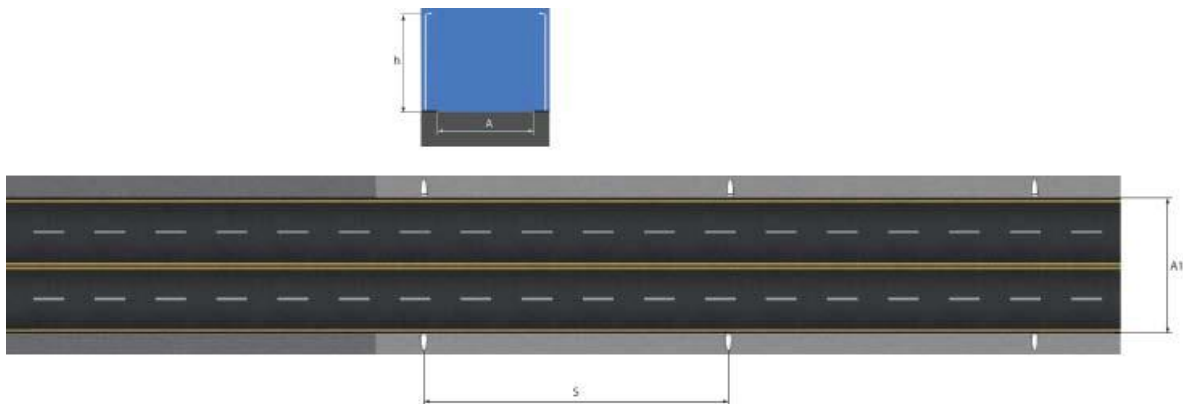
Vista de planta (Fuente Manual de iluminación vial SCyT)
